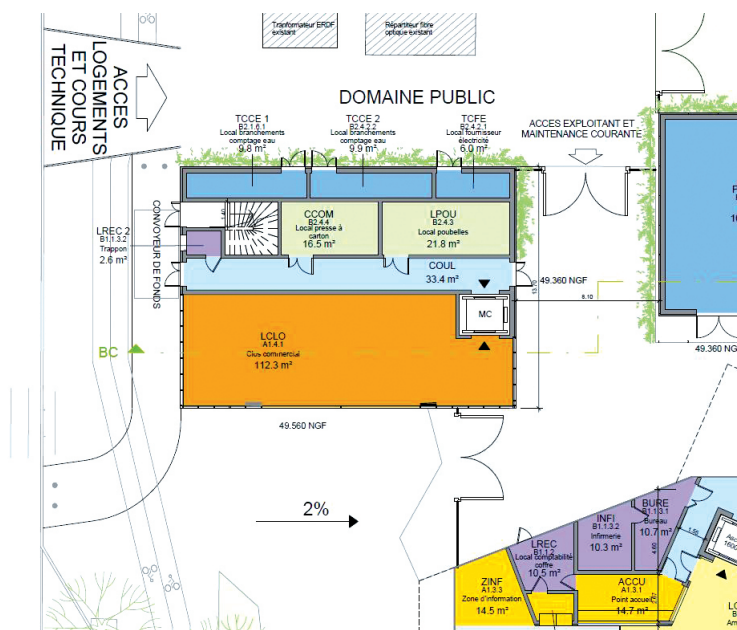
Extrait du plan R+0 - Emplacement convoyeur de fonds
